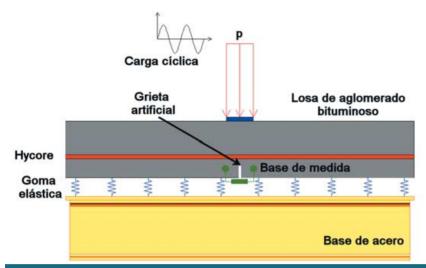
Esquema del ensayo de remonte de grietas.
